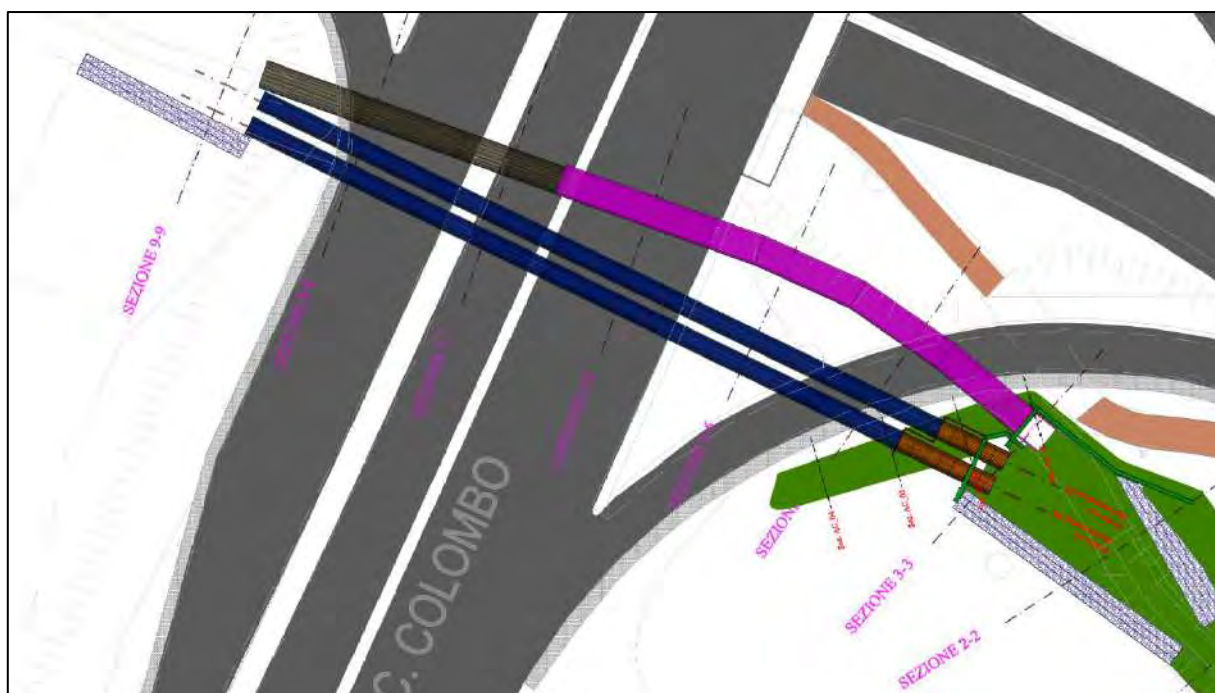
Planimetria area di intervento – in blu i due tubi oggetto del documento (2 tubi DN 2200mm)
